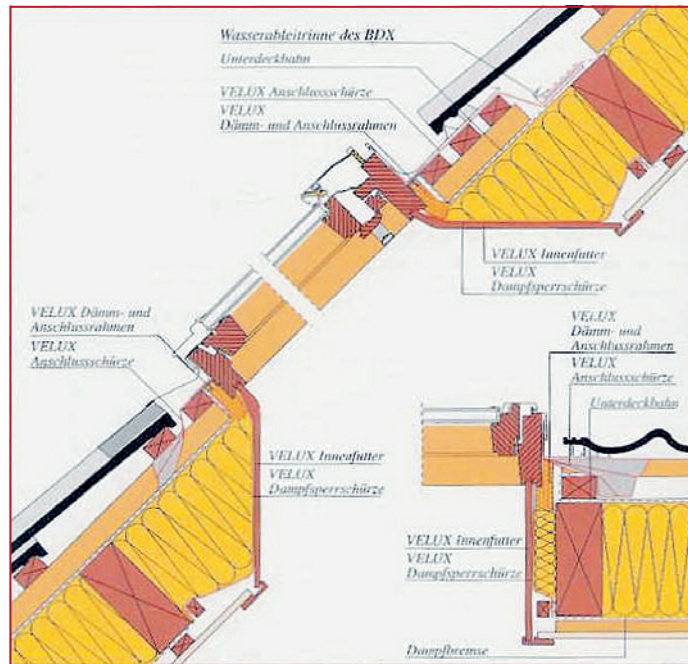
■ a) Dachflächenfensteranschlussdetails [Velux]
